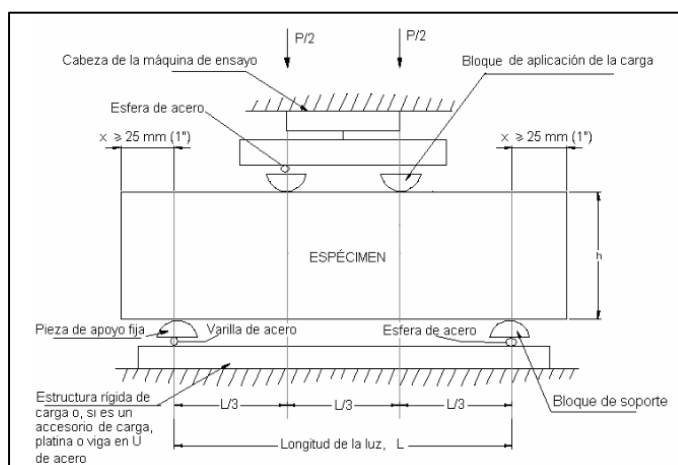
Esquema del equipo adecuado para el ensayo de flexión del concreto con el uso de vigas simplemente apoyada a los tercios
